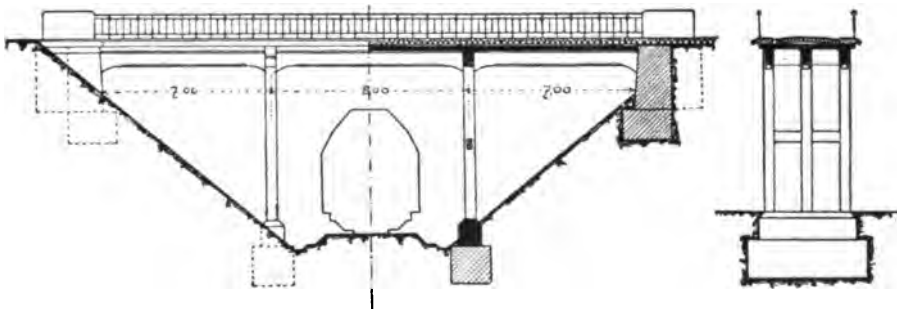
Eisenbetonbrücke über einen Bahneinschnitt.
